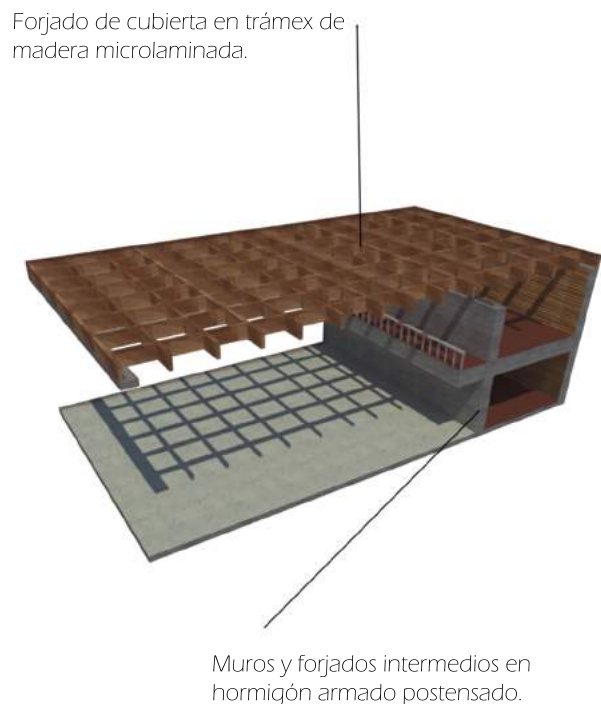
Axonométrica seccionada del módulo estructural del proyecto desarrollado. Elaboración propia.
